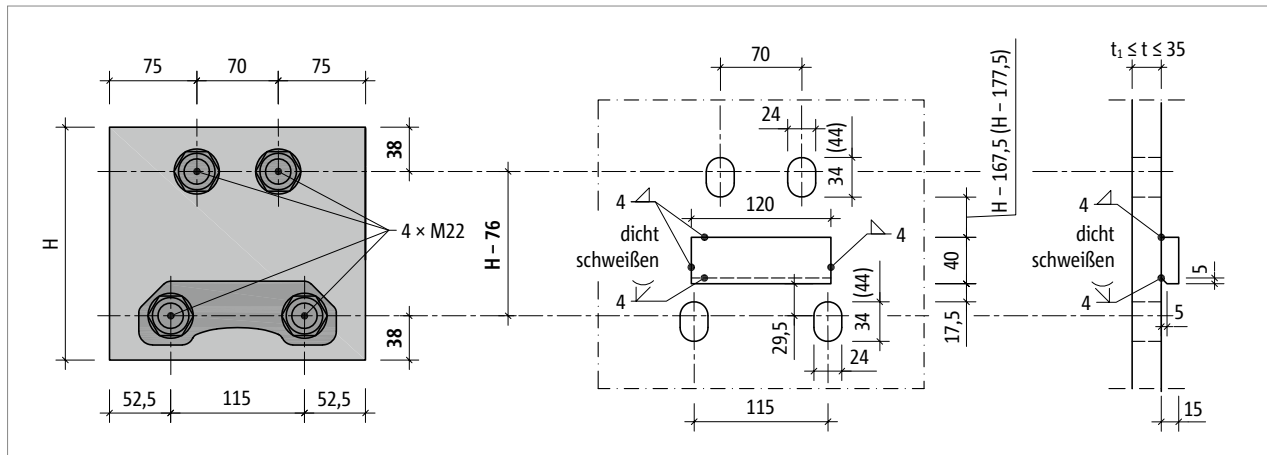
Schöck Isokorb® XT Typ SK-MM2...-CV28: Konstruktion des Stirnplattenanschlusses mit Betondeckung CV28
